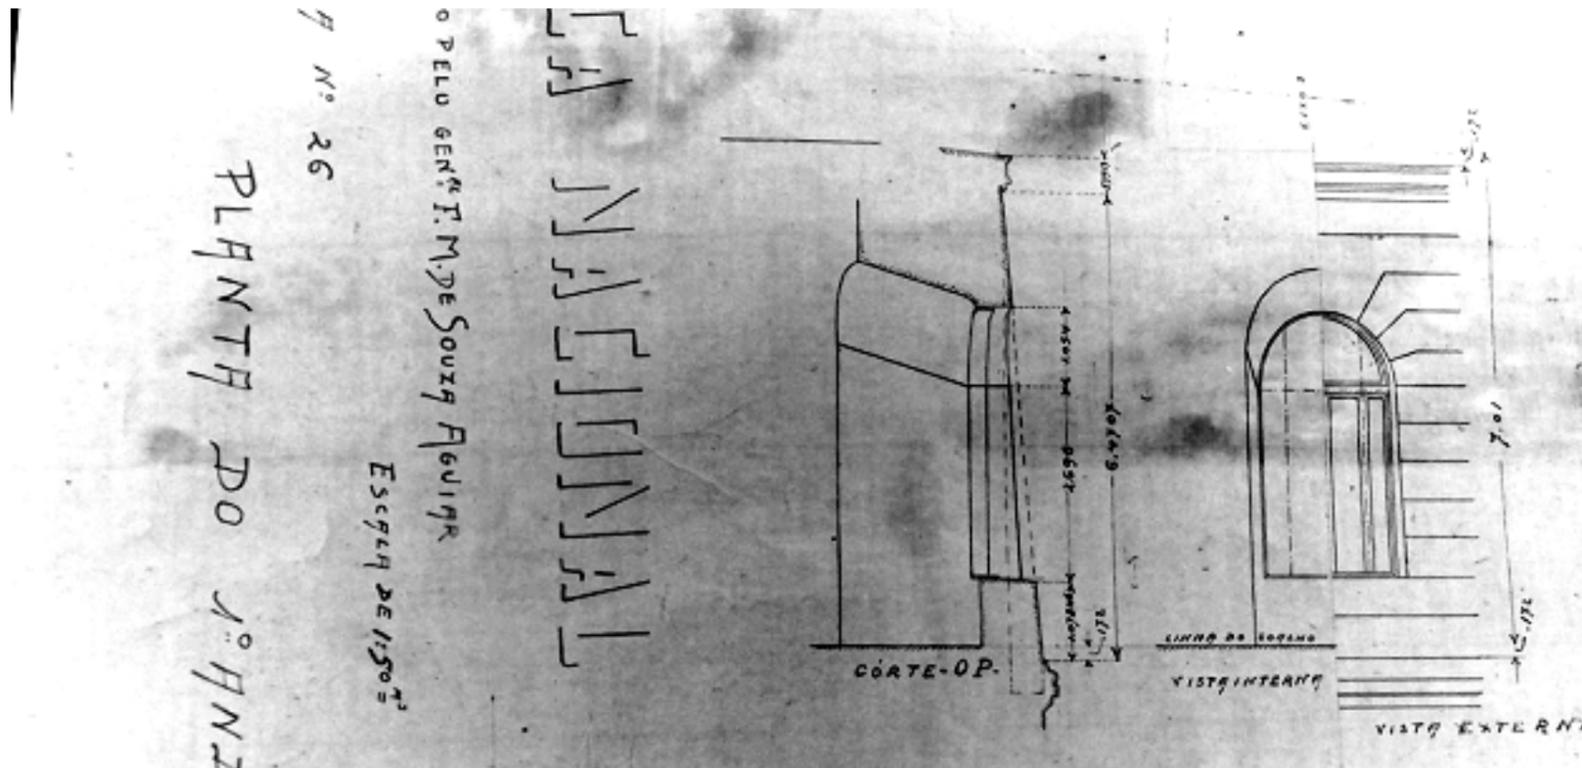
Detalhe contida na planta do 1º andar (nível do acesso pela Avenida). Junto da planta baixa há elevação de alguns trechos, com a marcação dos perfis utilizados nas vigas de piso e teto do pavimento e acabamento interno e externo dos vãos projetados nas empenas de fachada. Nesta ilustração, está representada a região de um dos 4 torreões projetados nos extremos da edificação Aguiar (sem data, Seção de Iconografia – FBN).
